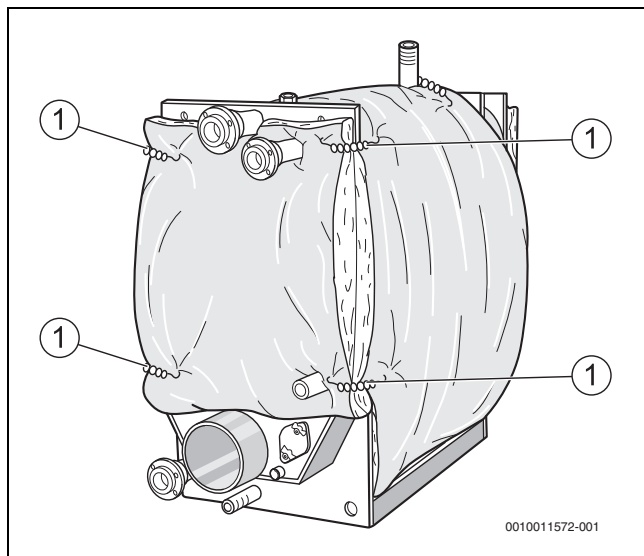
Укладка и крепление теплоизоляции задней стенки
